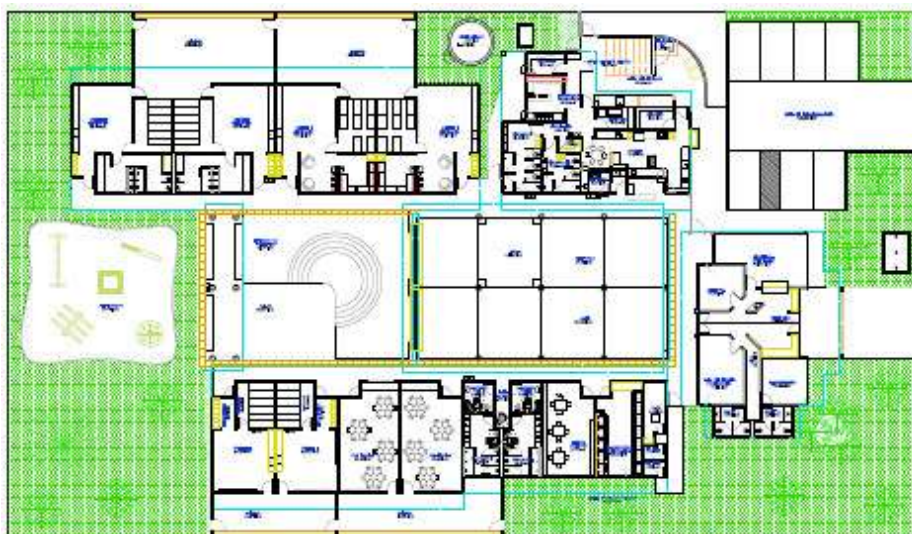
Planta baixa do CMEI - Centro Municipal de Educação Infantil Criança Feliz
